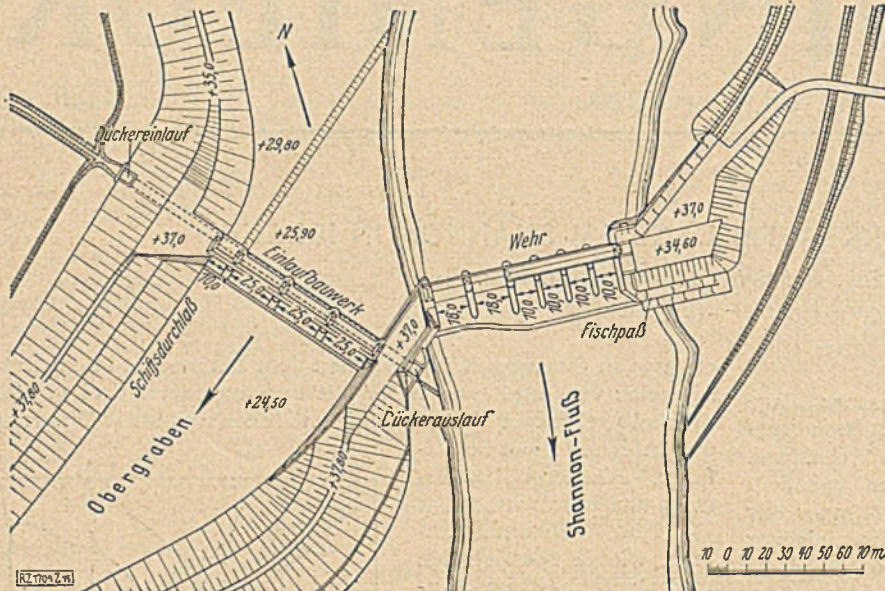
Wehr und Einlaufbauwerk (Lageplan).
